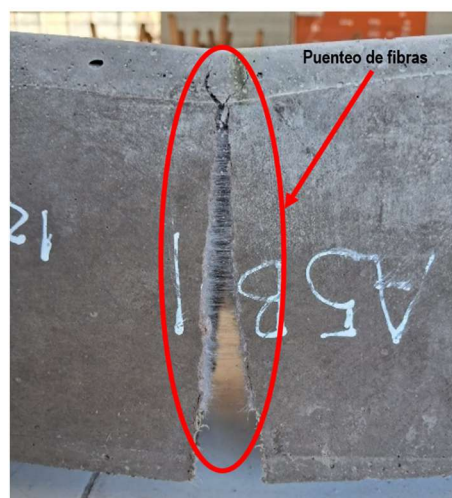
Puenteo de fibras tras la fisuración en ensayo de fractura.
